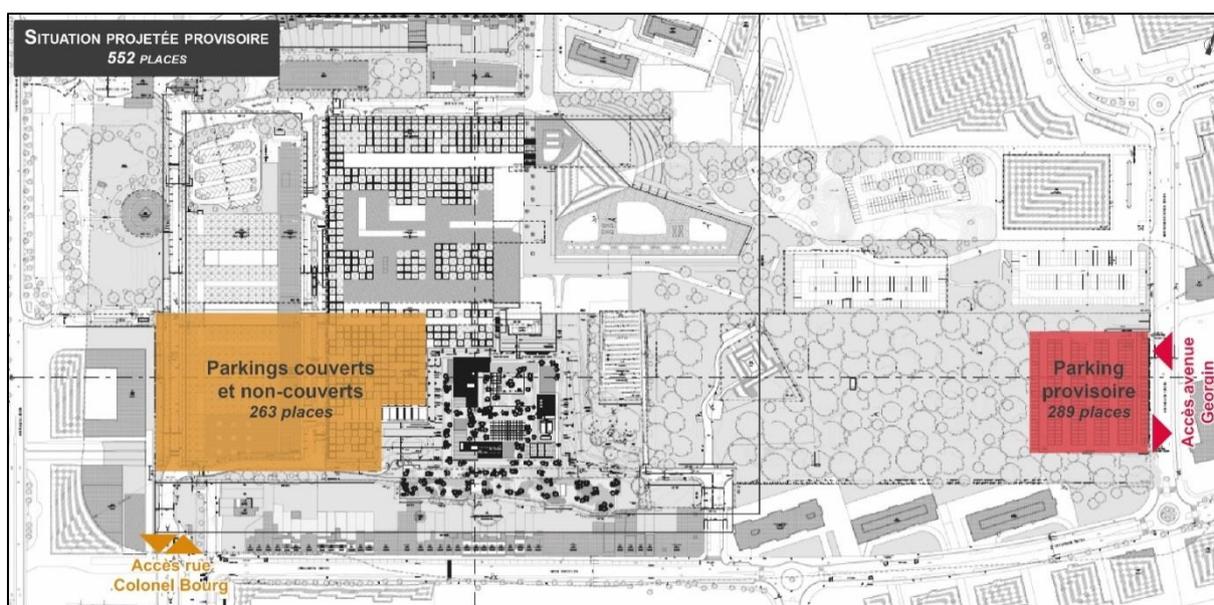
Organisation du stationnement sur le site en situation projetée transitoire
